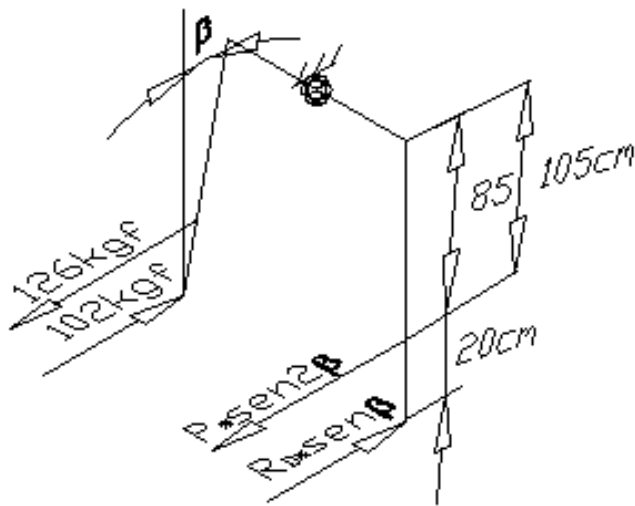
Carga en el plano perpendicular al plano del pórtico.
